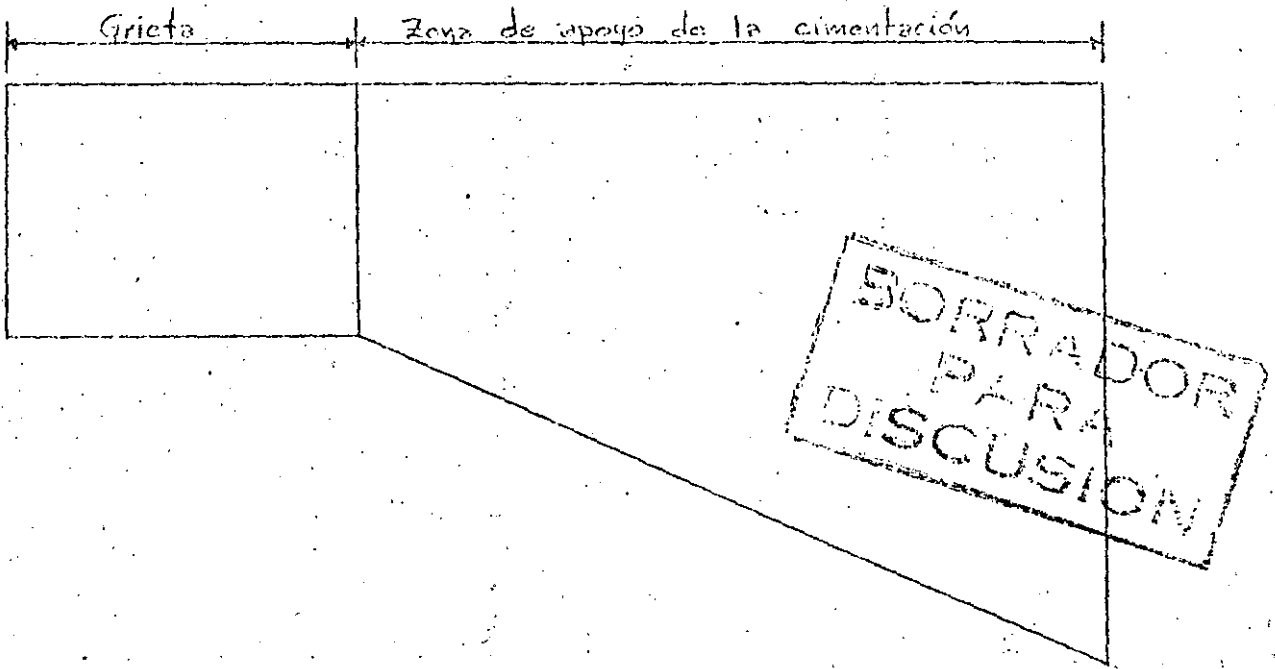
Grieta y zona de apoyo de la cimentación en una presa de gravedad.
